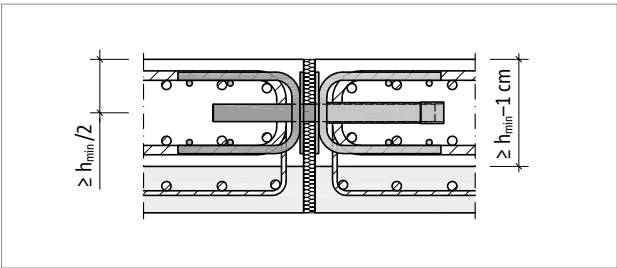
Stacon® SLD: Bauseitige Bewehrung bei Elementdecke
